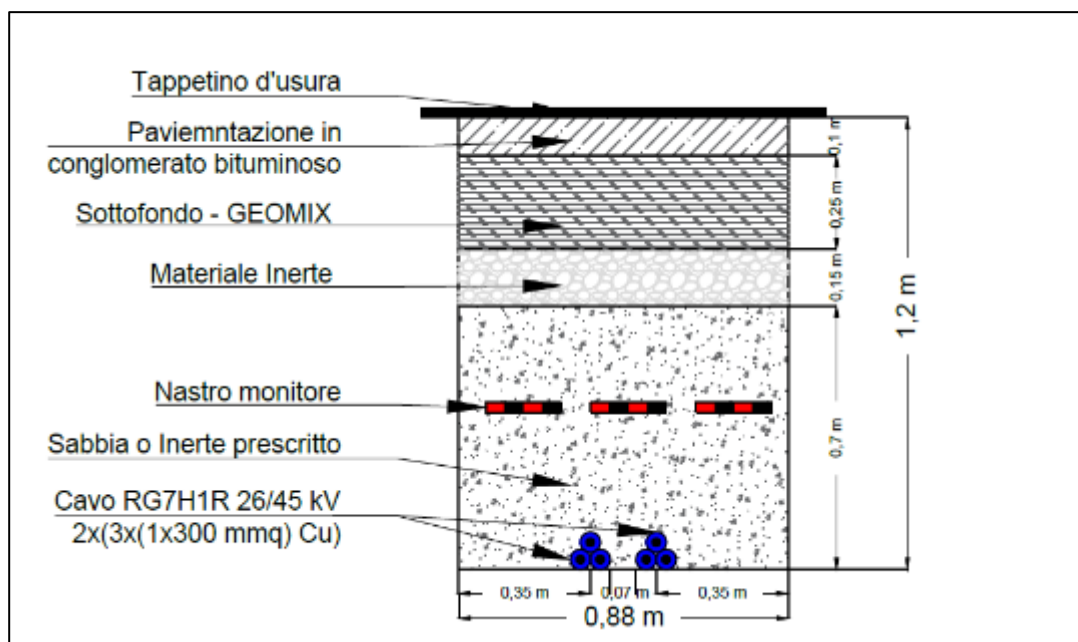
Tipico della sezione di scavo del cavidotto di connessione a 36 kV su strada asfaltata
